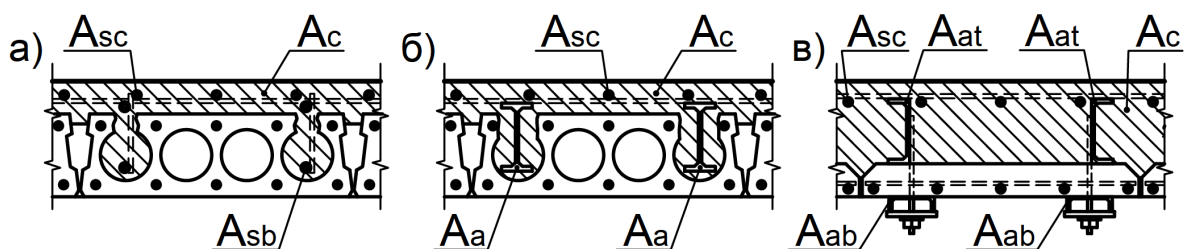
Варіанти підсилення перекриттів приміщень сховищ із збірних залізобетонних плитних конструкцій шляхом збільшення їх перерізів за допомогою: а) арматурних каркасів і сіток; б), в) сталевих профілів і арматурних сіток
